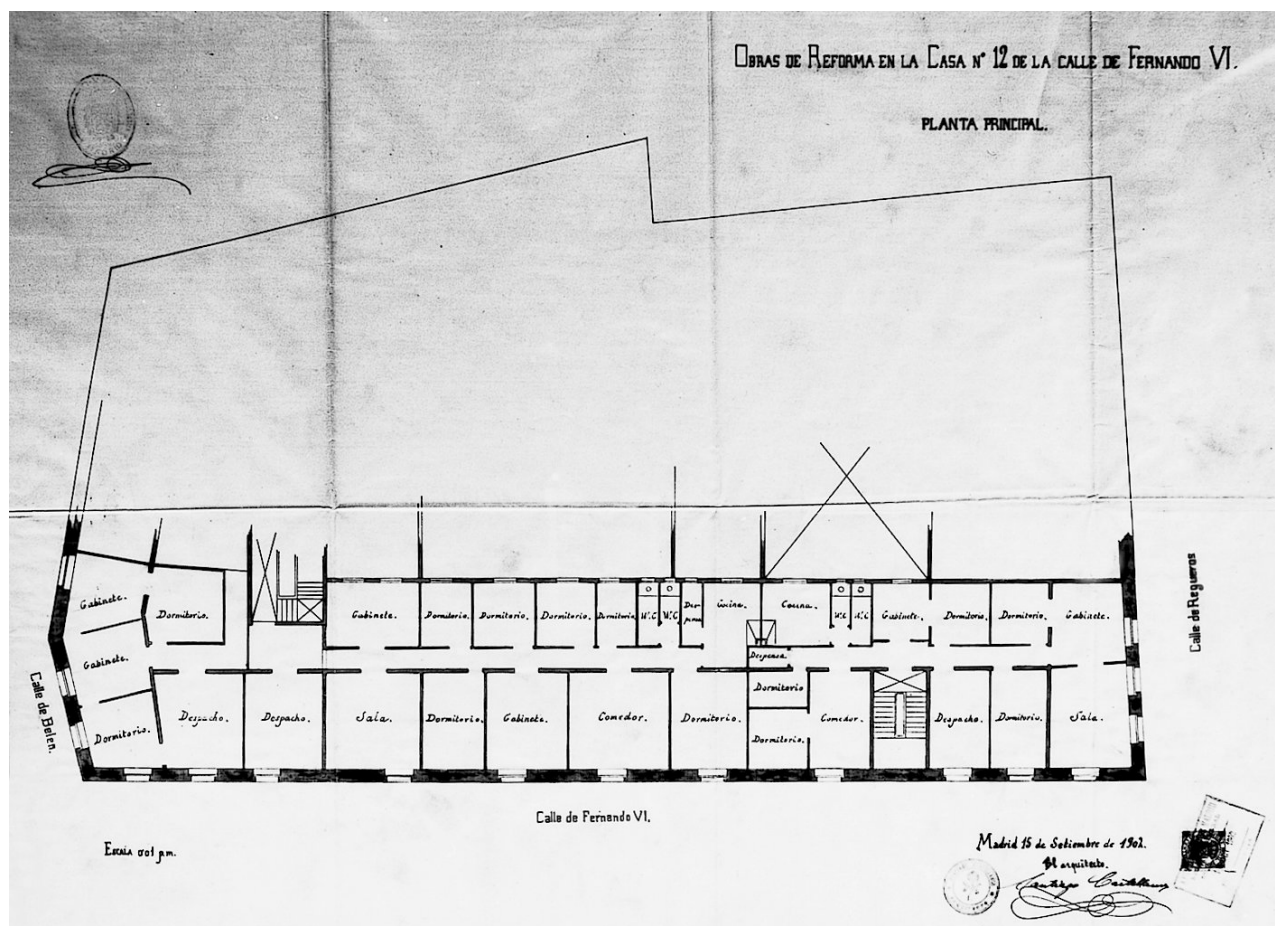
Planta principal de la nueva sede de Lamarca Hnos., 1902. Arquitecto: Santiago Castellanos Urizar. AVM: 16-20-48. En ella pueden verse esbozadas las líneas de arranque de los muros preexistentes que se prolongan hacia la parte conservada.
